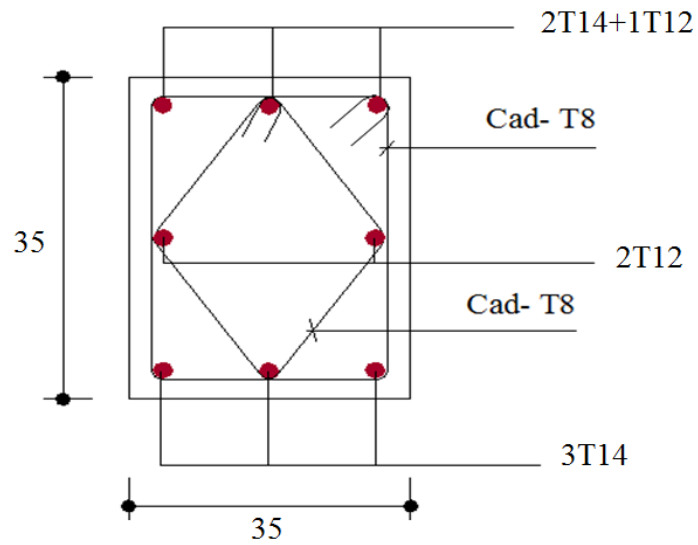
Schéma de ferrailage de la poutre brisée de l'escalier type II.
